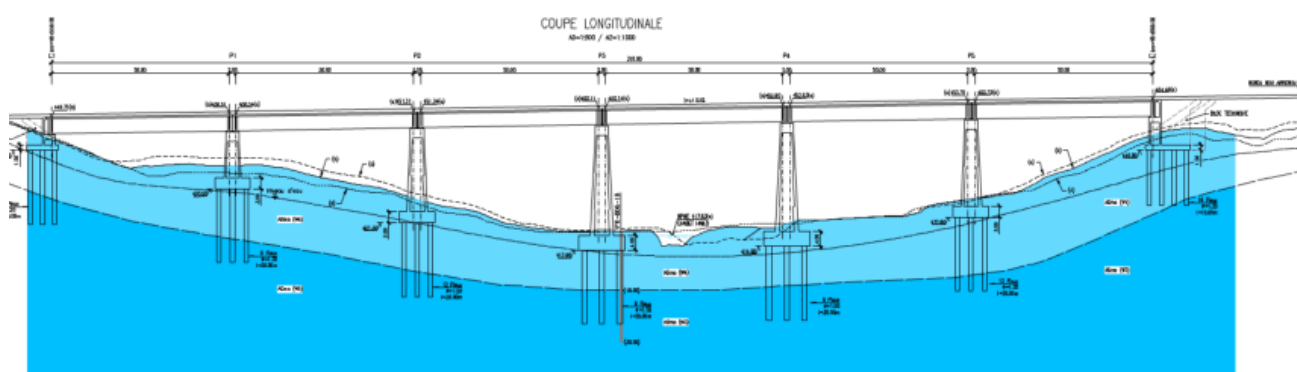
Coupe longitudinale du pont à poutre précontrainte par post-tension.
